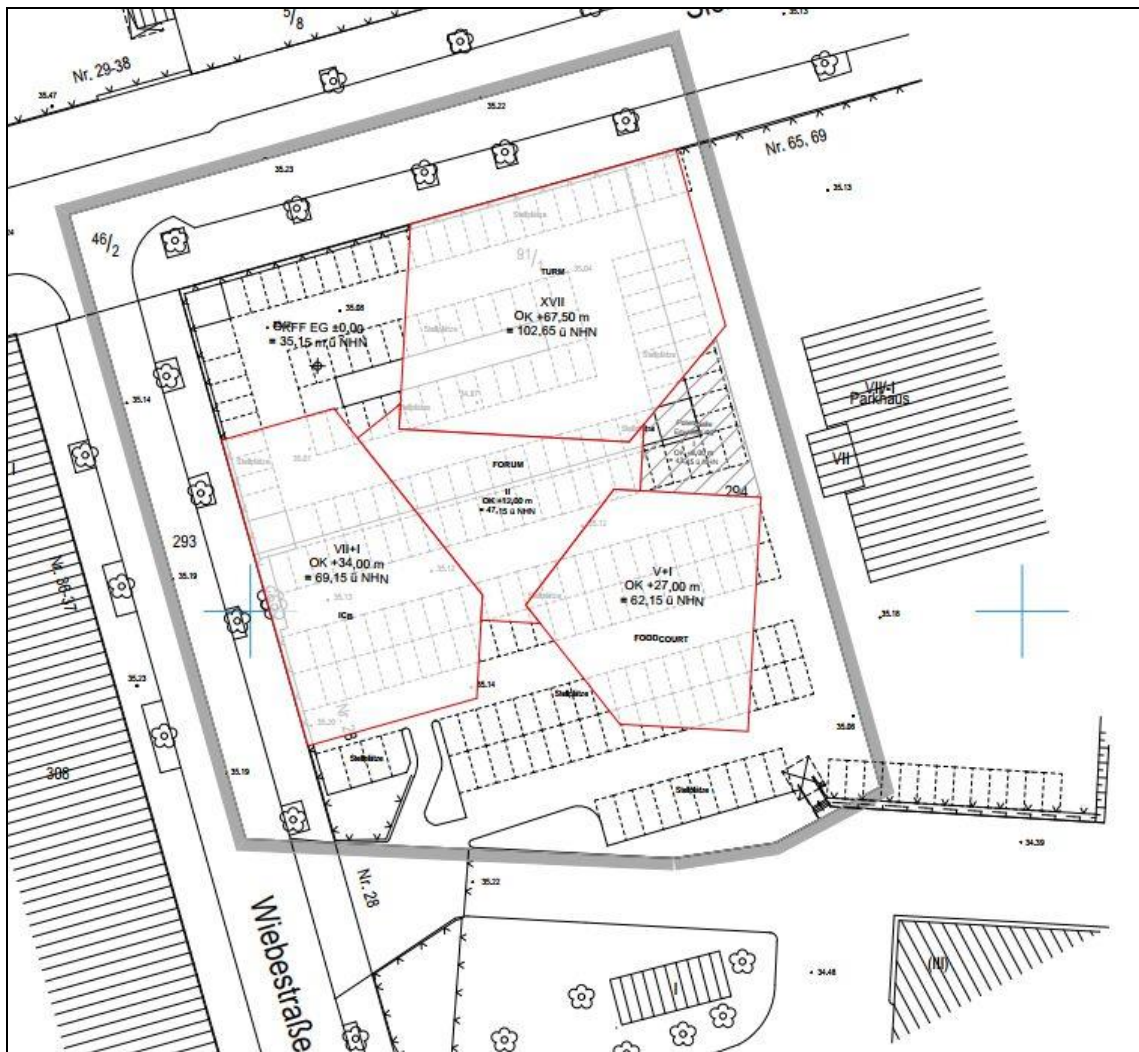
Bebauungsplan 1-124 Bezirk Mitte, Ortsteil Moabit, Sickingenstraße (Ausschnitt aus der Planzeichnung)
